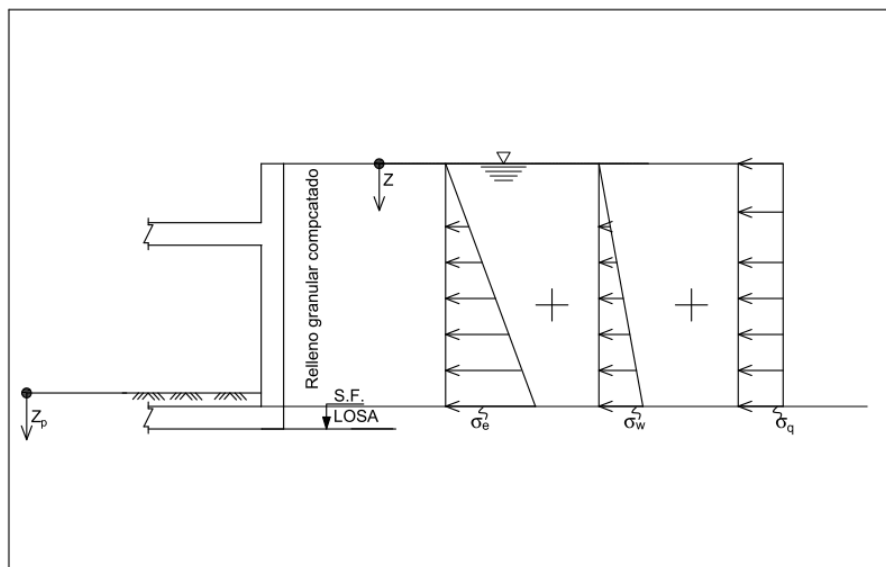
Muro Restringido al Giro Carga. Caso Estático.
